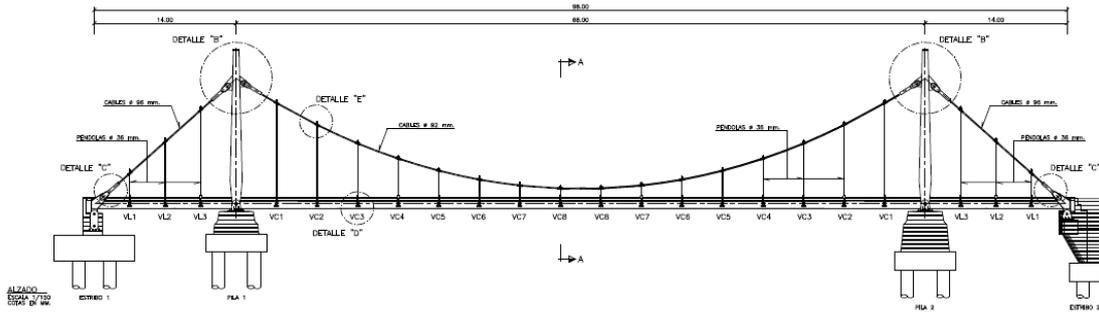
Alzado del Puente en Virgen de la Peña
